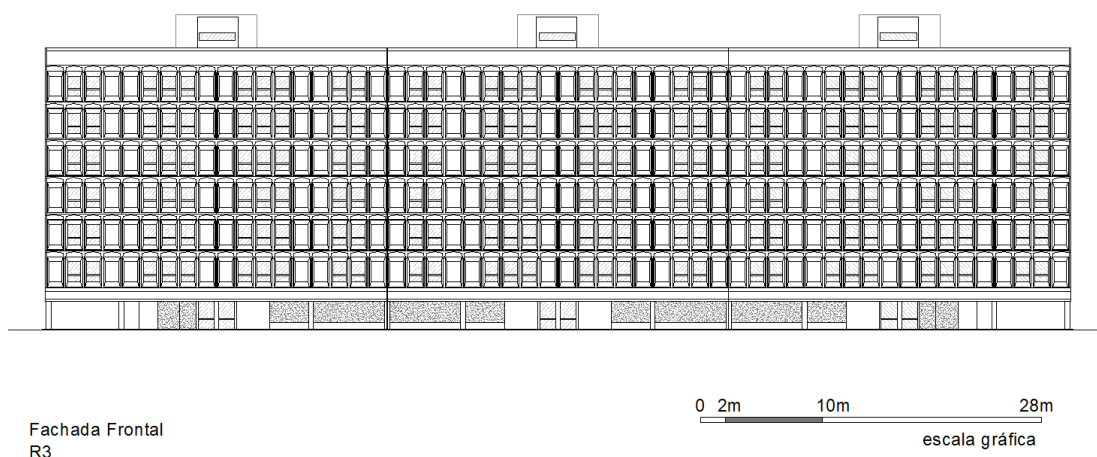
Fachada frontal do R3. Fonte: da autora, adaptado das pranchas originais do Acervo do Arquiteto Milton Ramos.
